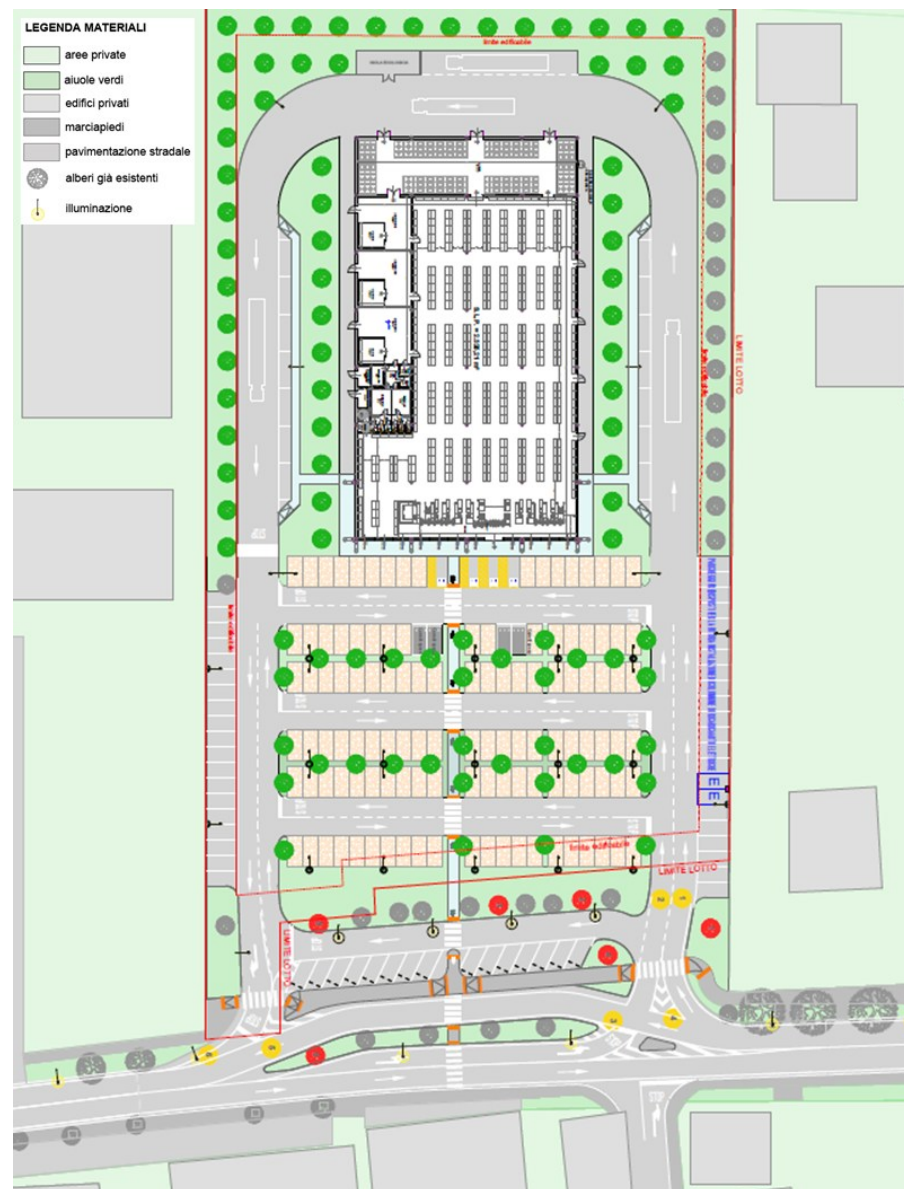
Planimetria di progetto opere di urbanizzazione via San Giorgio
